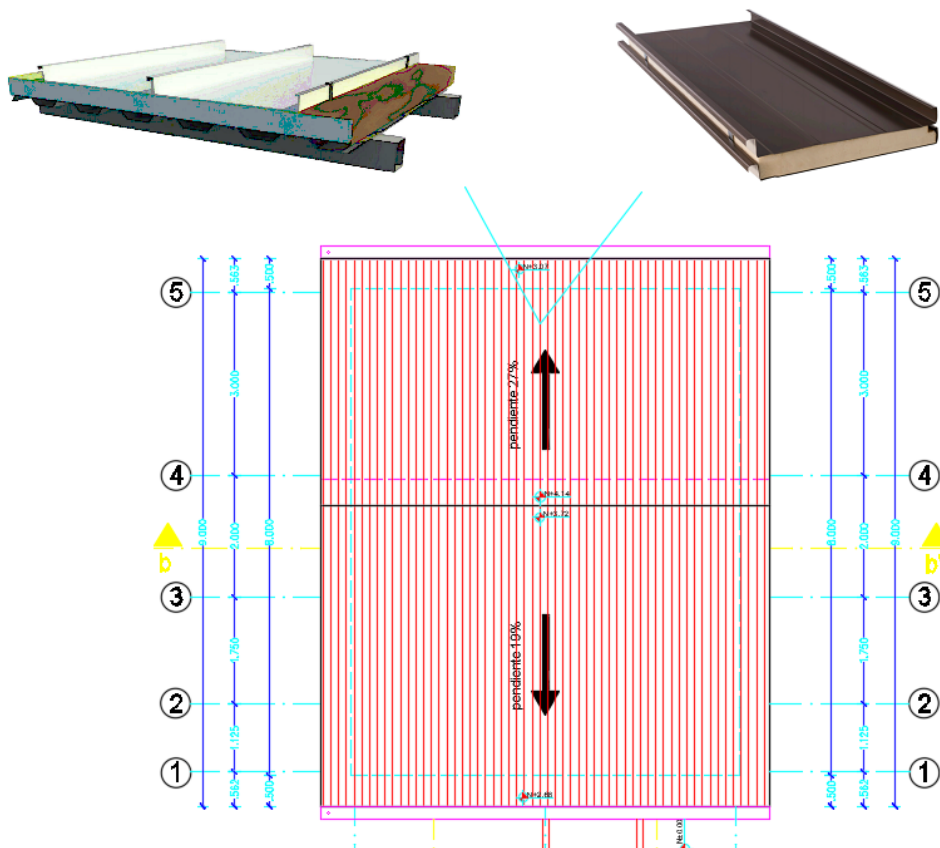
Planta de cubiertas según el nuevo panel instalado.
